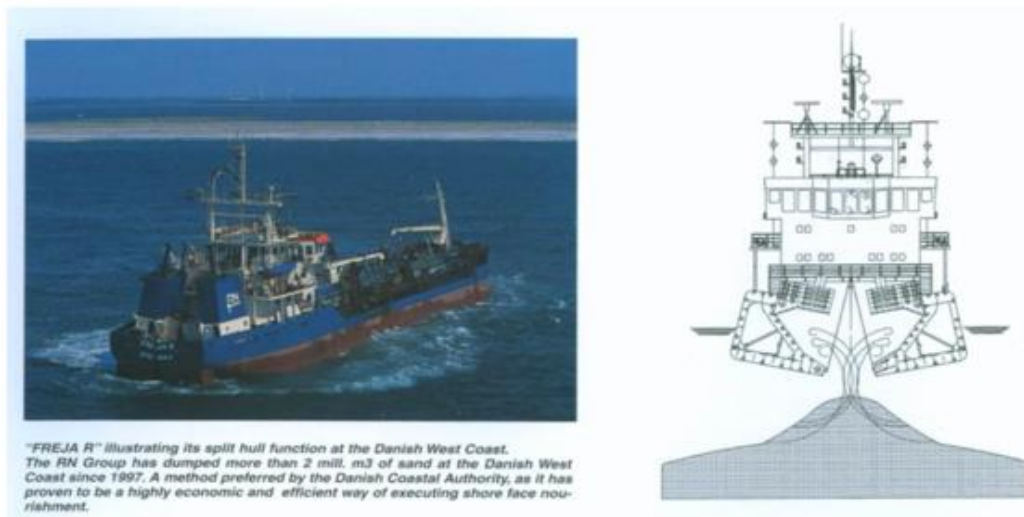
Draga Hidráulica de Sucção em Movimento (Fonte: [36])
